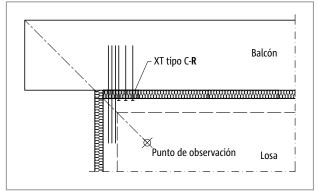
Schöck Isokorb® XT tipo C: Balcón voladizo sobre la esquina del edificio (utilización de XT tipo C-R)
